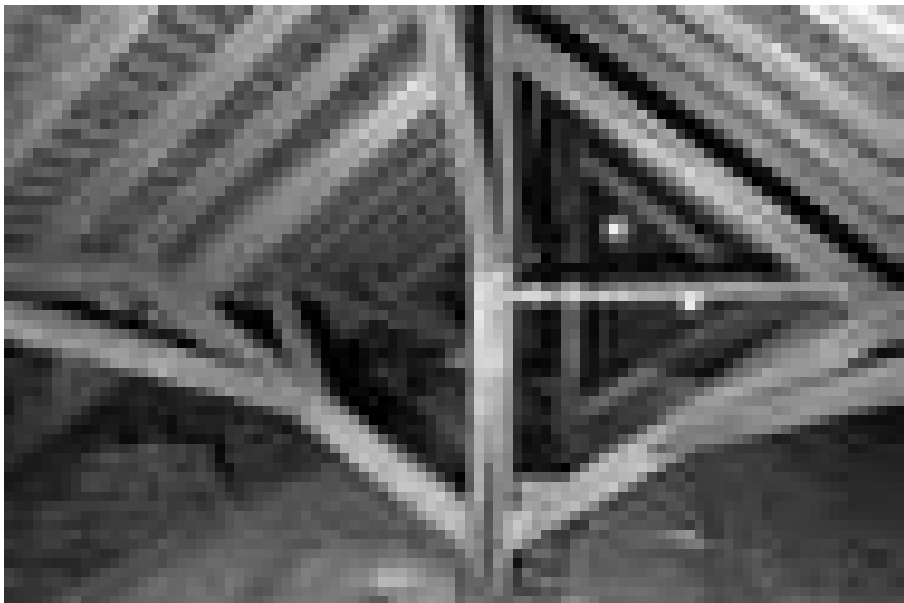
Mühlhausen/Würm, evangelische Pfarrkirche, Dachwerk
